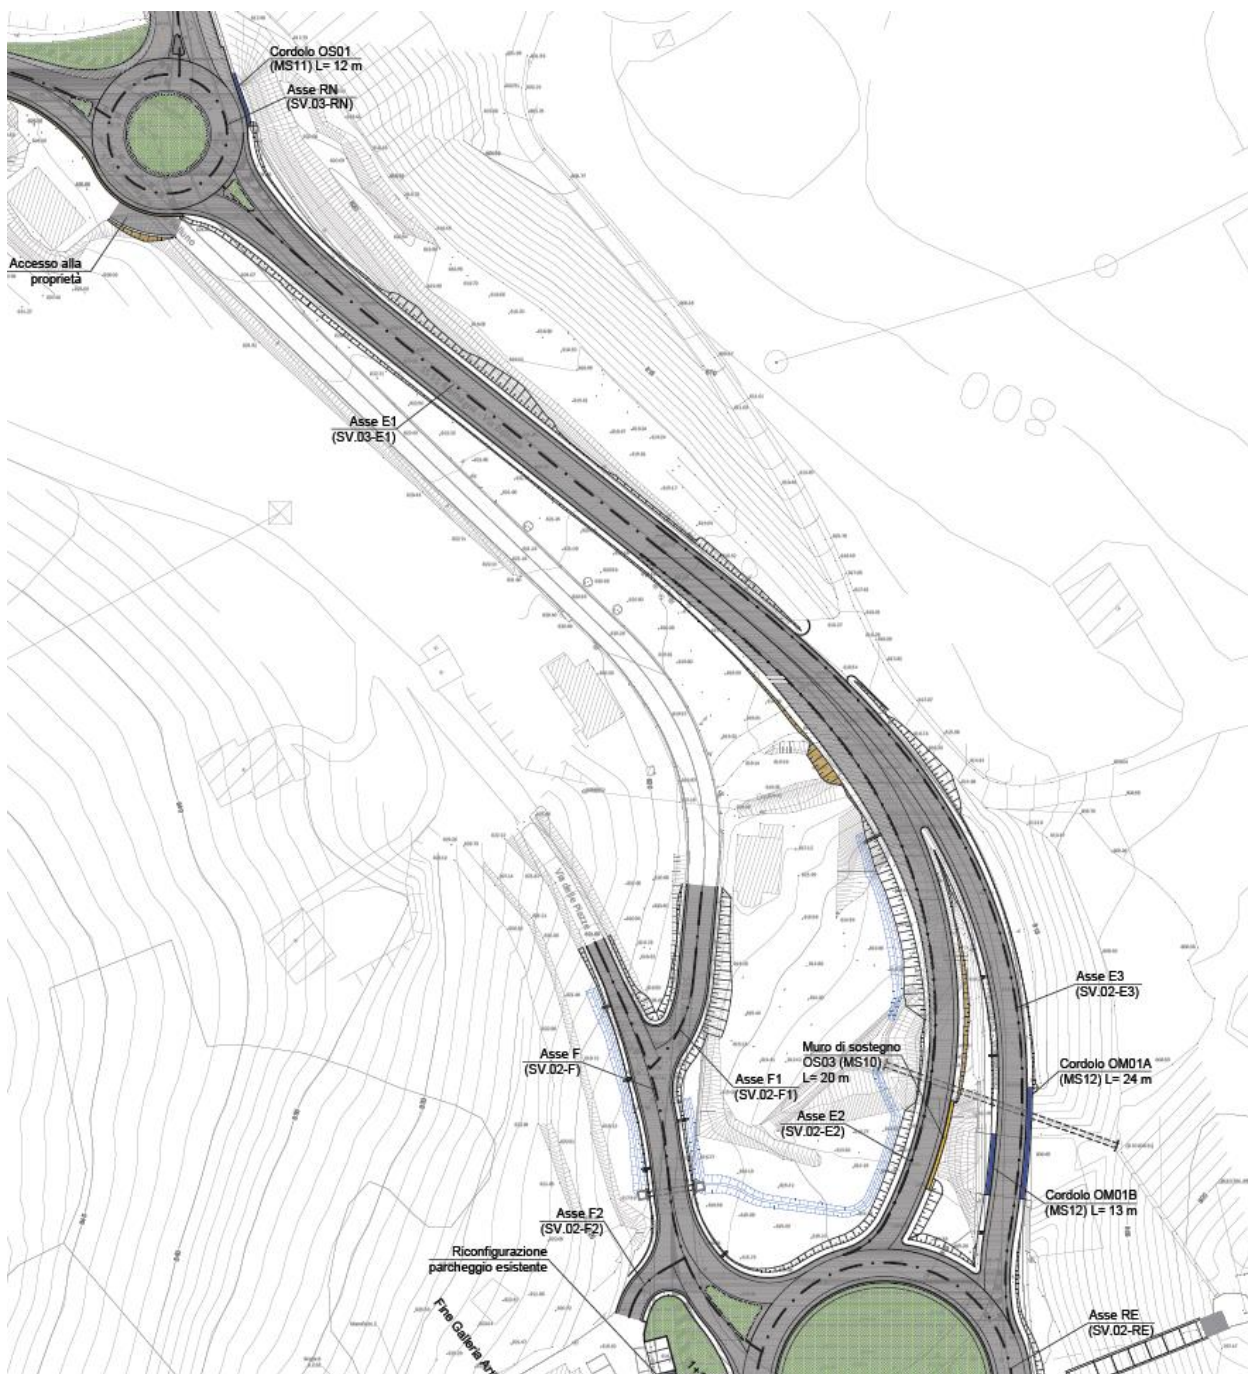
Stralcio planimetrico connessione Assi E1, E2, E3
